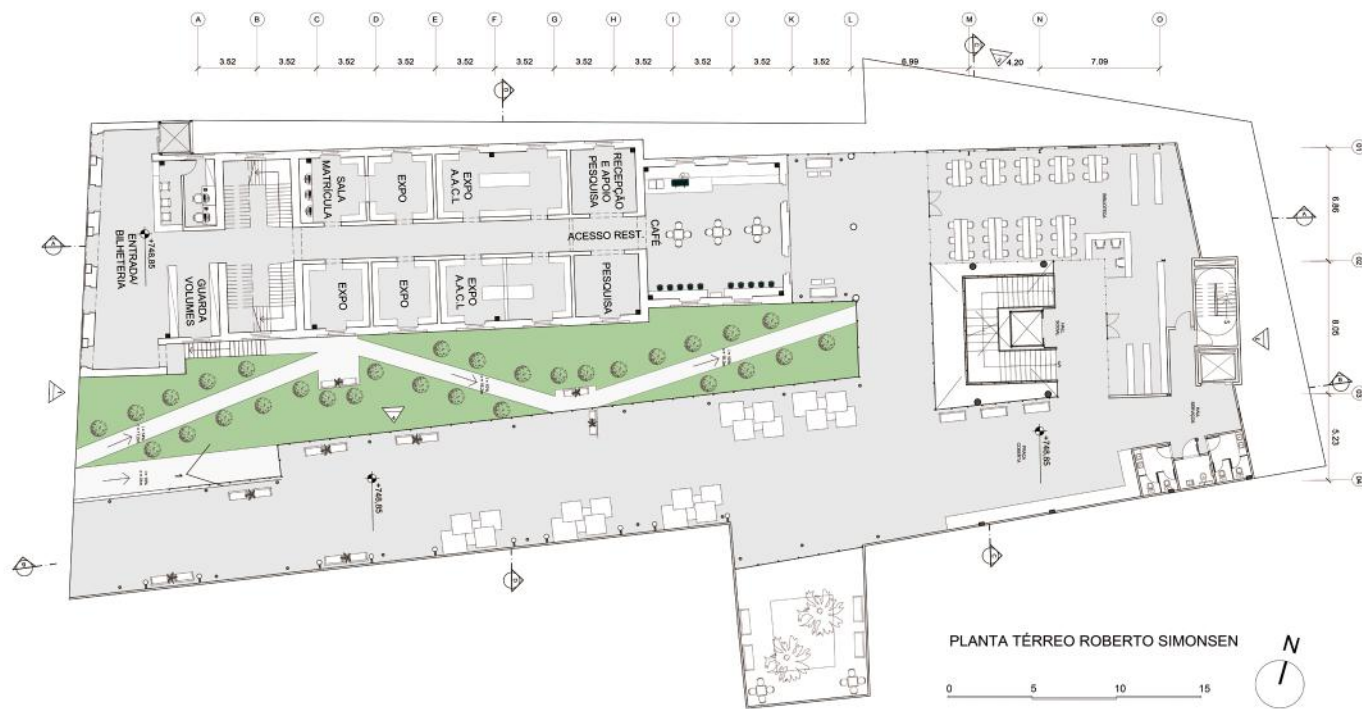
Planta Térreo (Rua Roberto Simonsen) | Projeto de Laís Paraizo, 2019.
